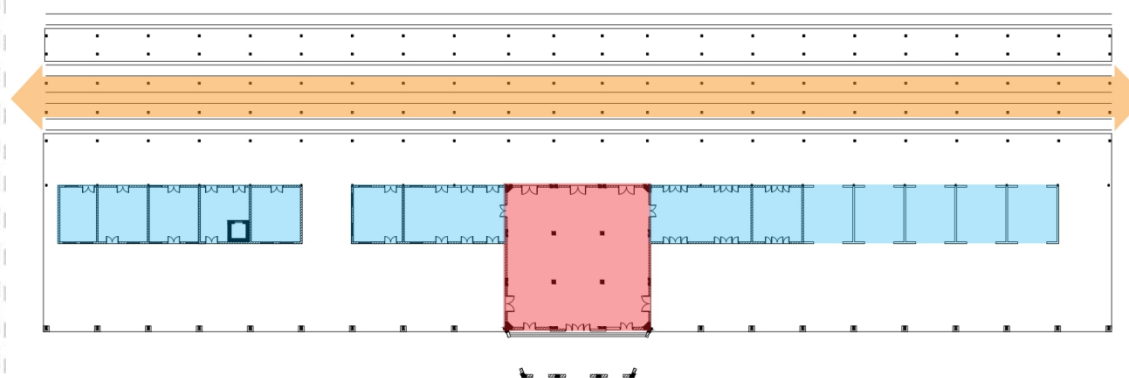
Denah Ruang Stasiun Cirebon Tahun 1914
